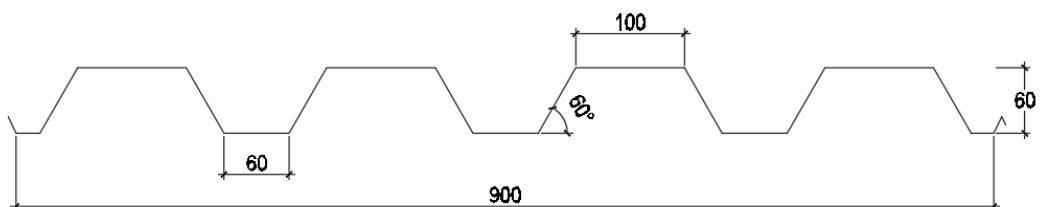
Dimensiones del perfil AD-600 (mm).
